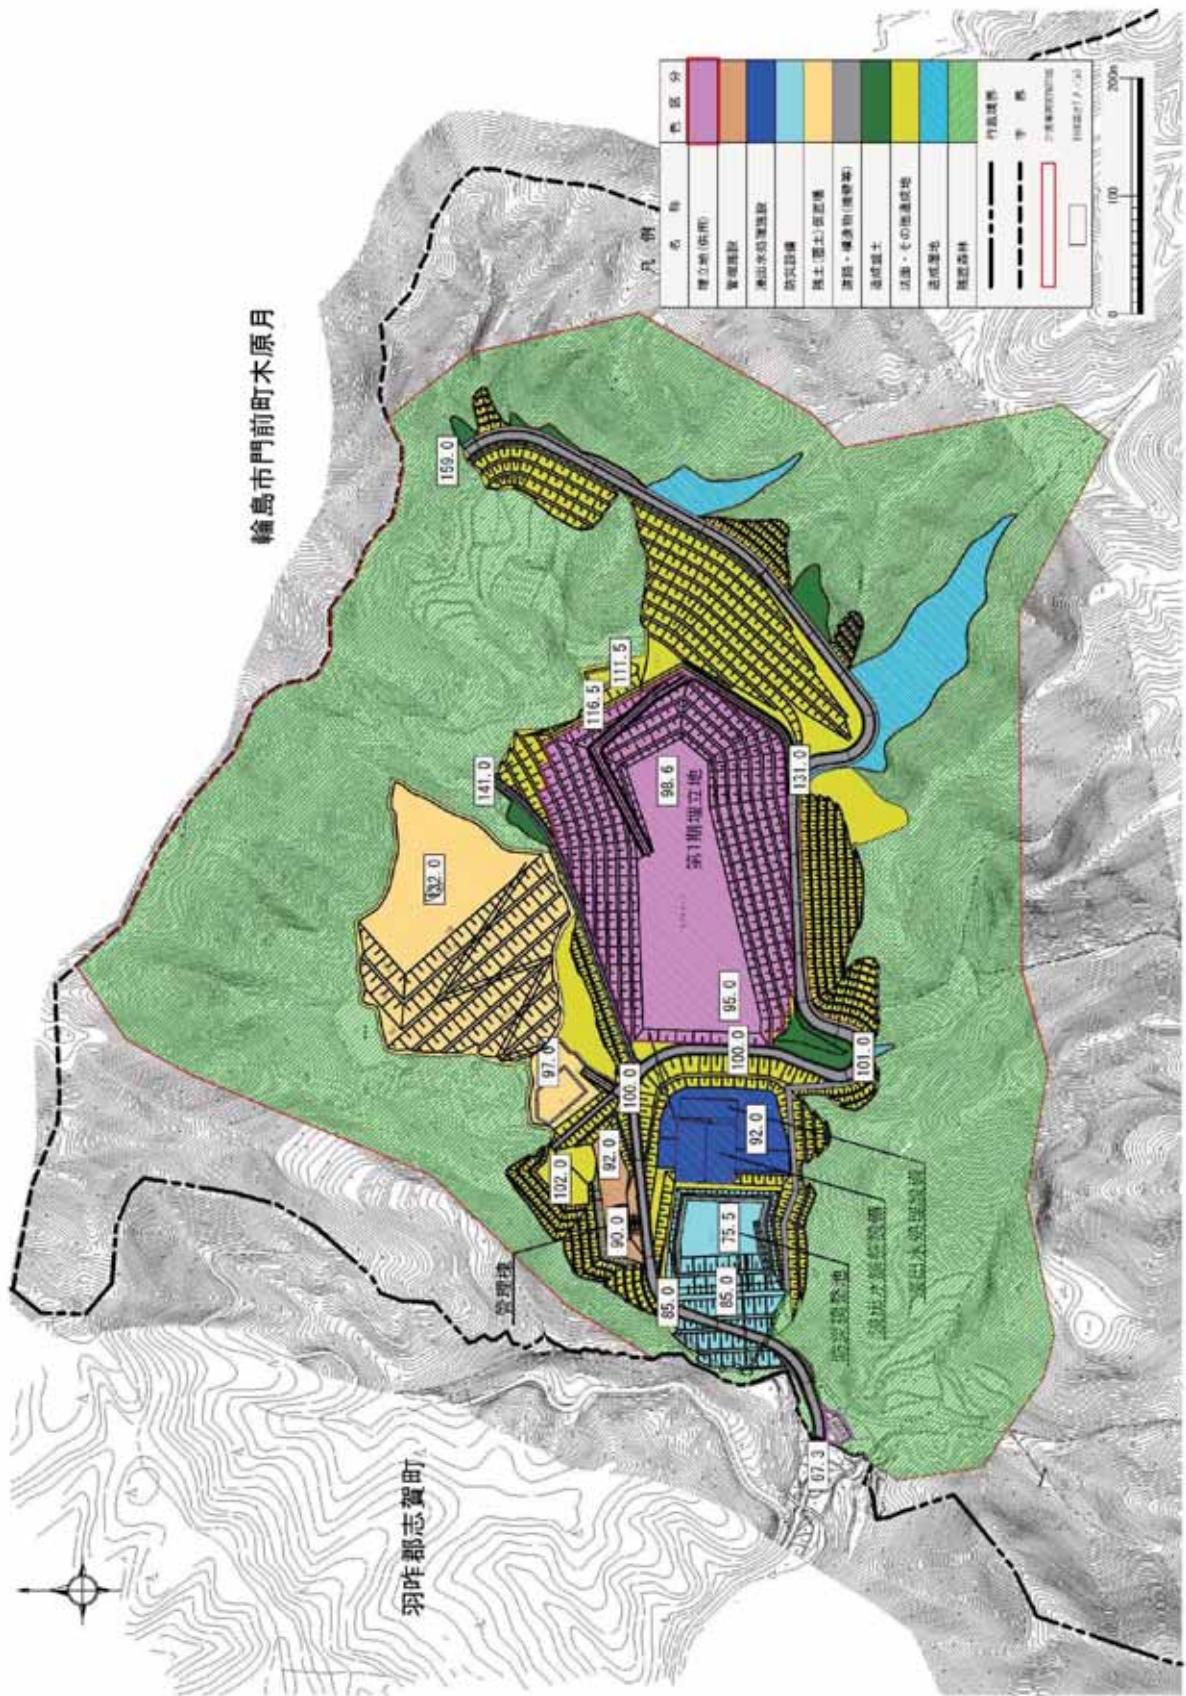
造成・施設配置計画平面図(第 1 期整備)
